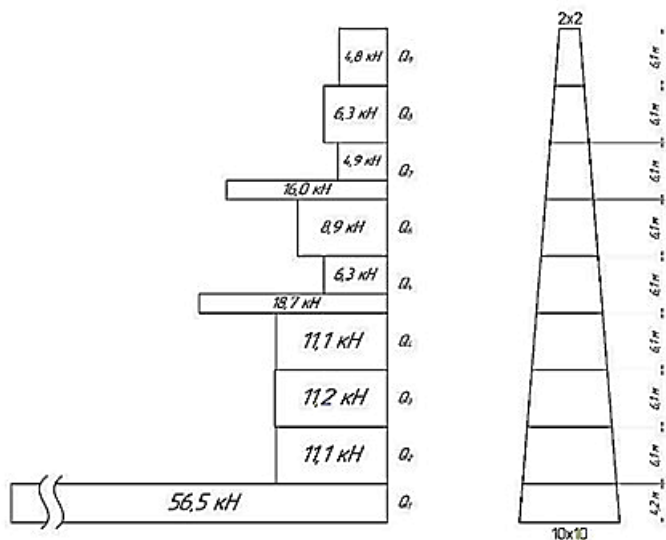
Эпюры ветровой нагрузки на буровую вышку ВБ53-320
